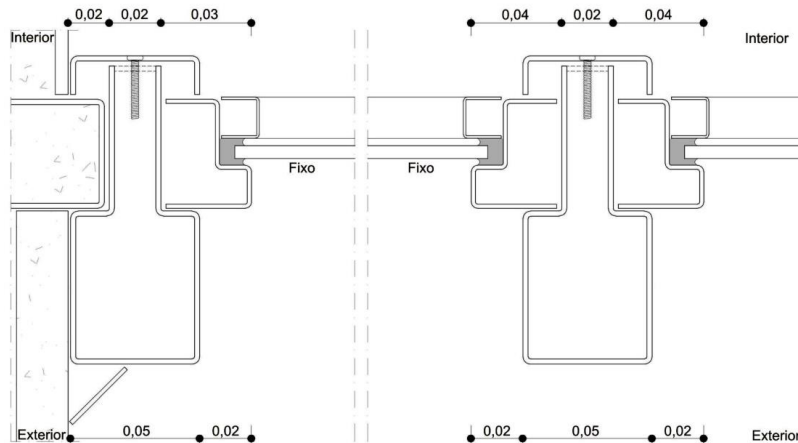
Anexo 1 do Senado Federal, fachada sul. Pano de vidro. Planta baixa 1. Adaptado a partir de desenho do DETEC/CD, 2013. (MACEDO, LIMA, & SILVA, 2013).
